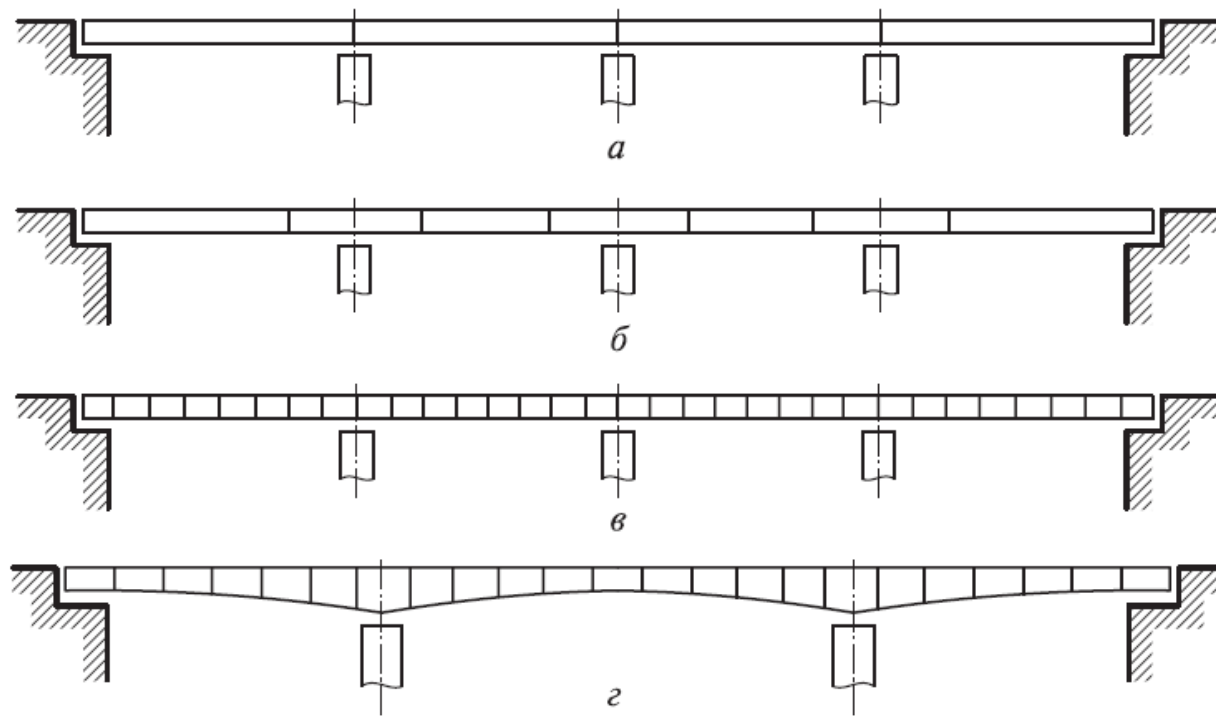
Виды (а — г) сборных и монолитных неразрезных пролетных строений
